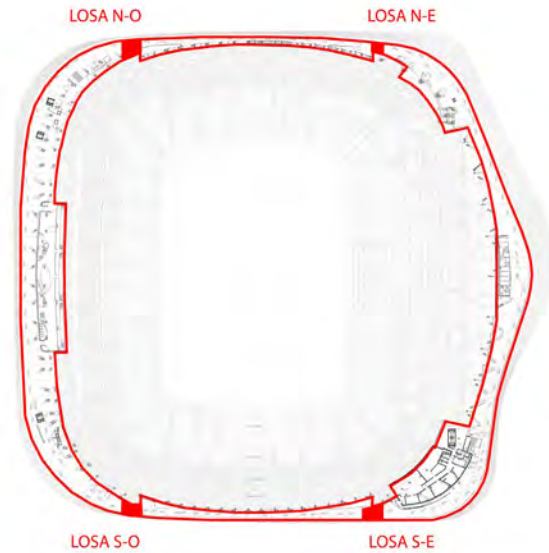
Planta general skywalk en Nivel 10 y ubicación de las losas de transición. Imagen generada para esta publicación.
